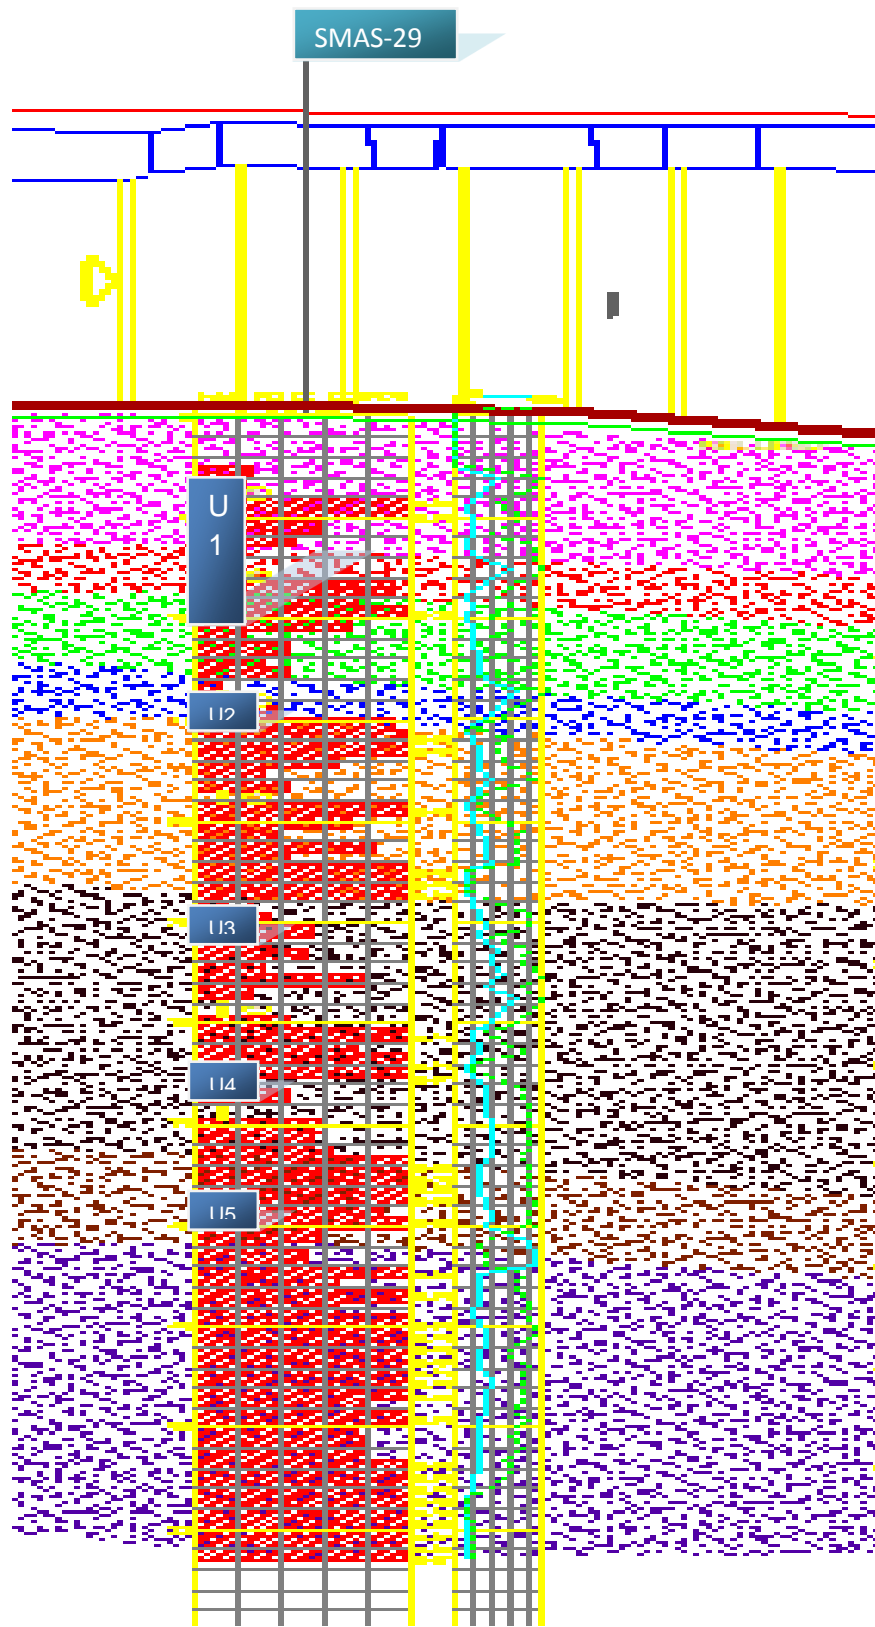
Zonificación geotécnica. Pilas Oblongas - Zona II
